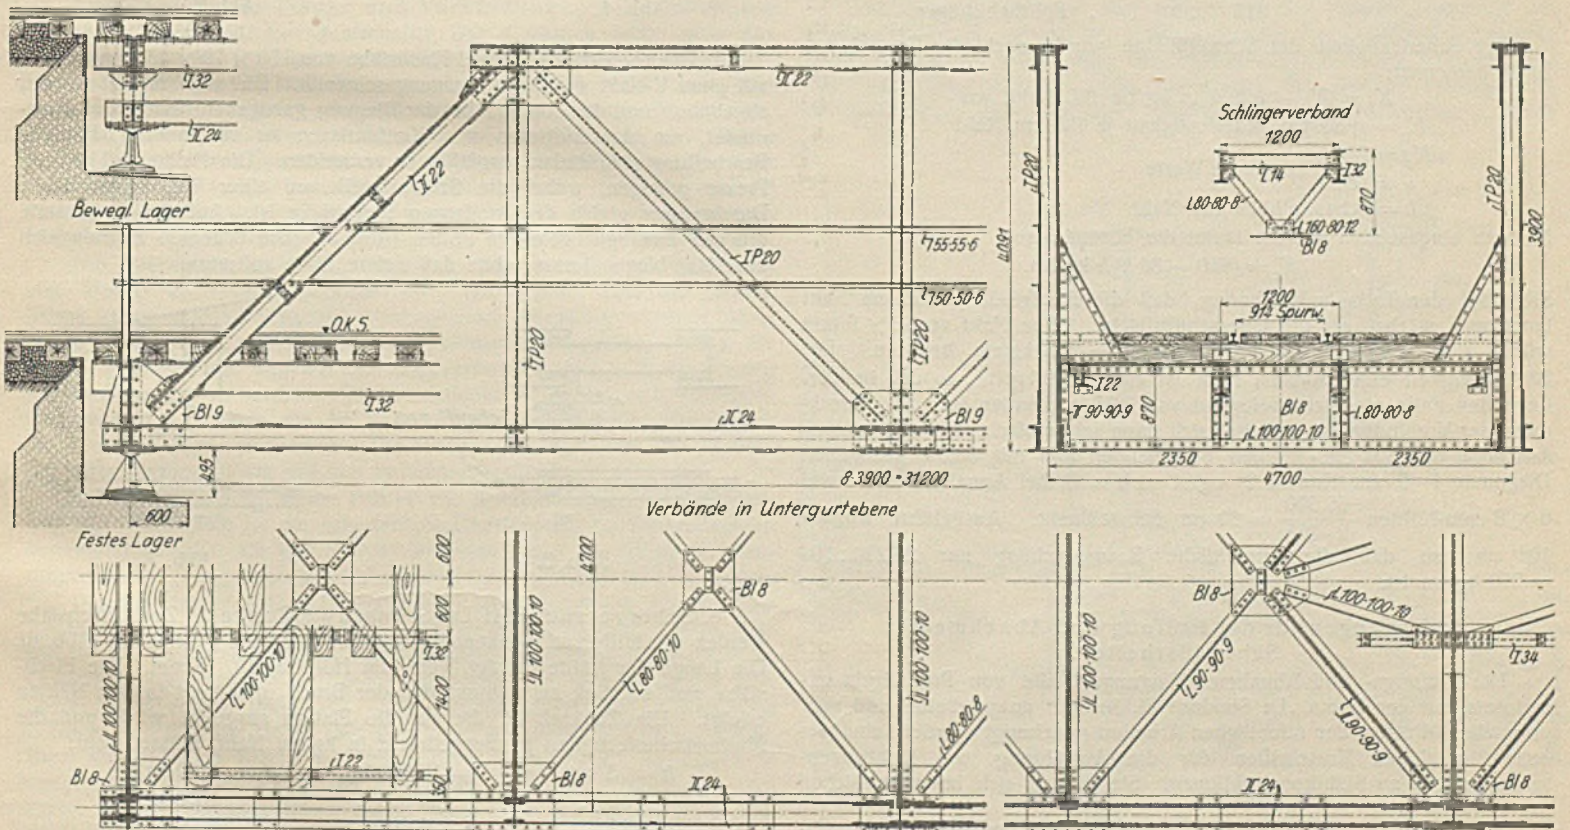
Eisenbahnbrücke mit beschränkter Bauhöhe.
